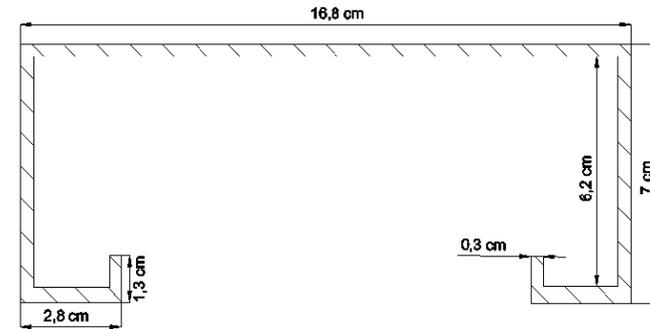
Schéma de la section d'un profil métallique d'un pieu battu
